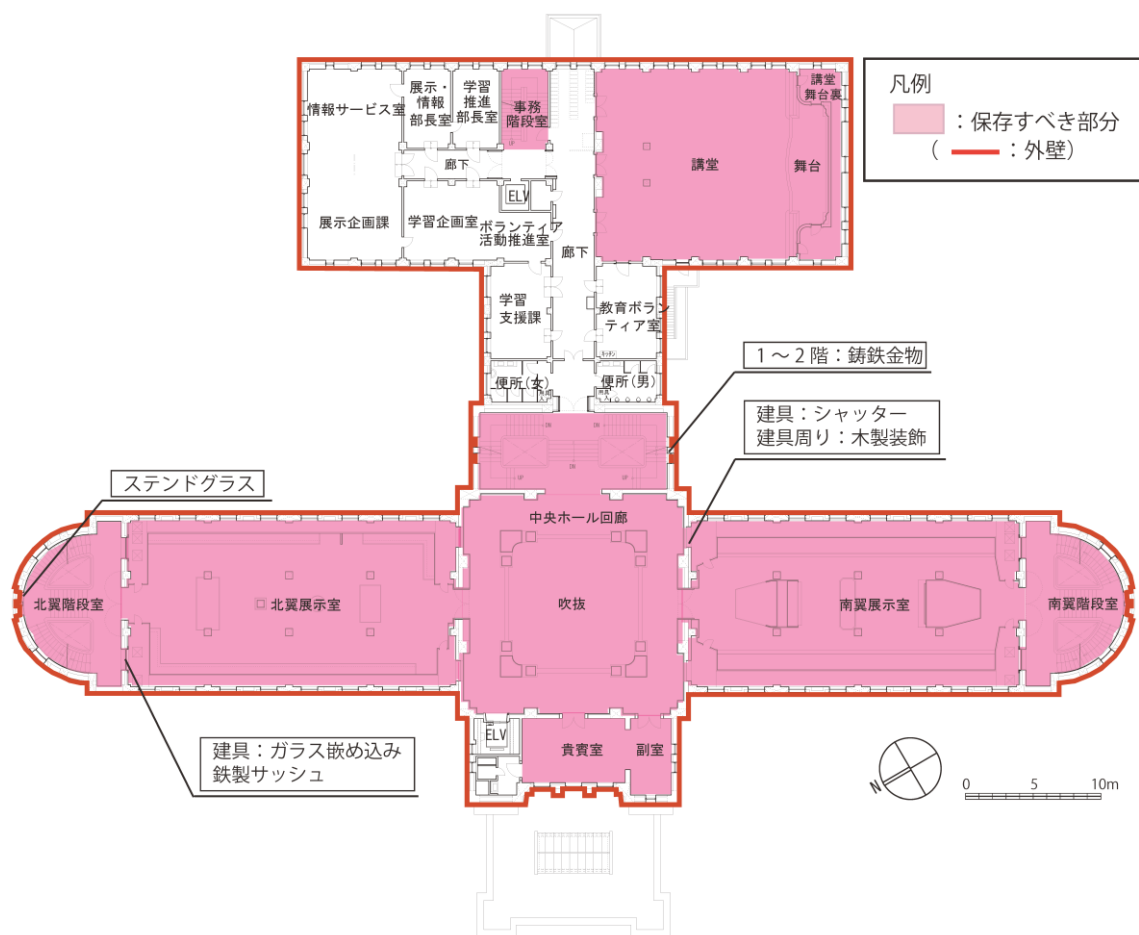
保存すべき部分 2階平面図 (改修前2階平面図に加筆)
